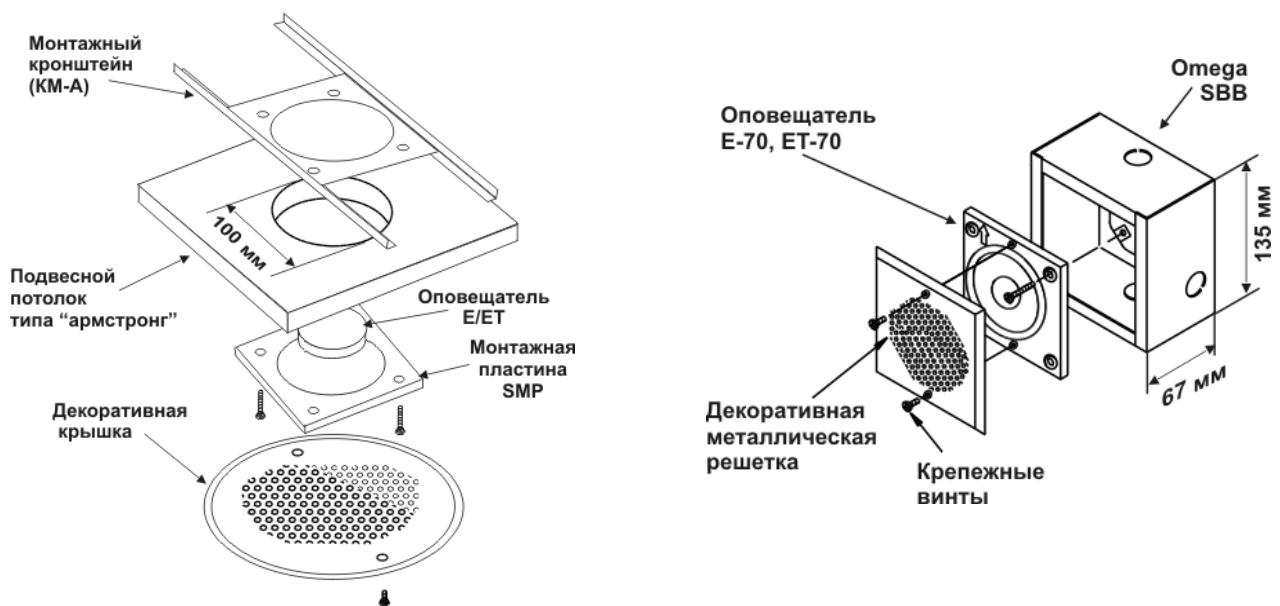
Габаритные размеры монтажной пластины SMP и размеры потолочных отверстий для установки оповещателей.
